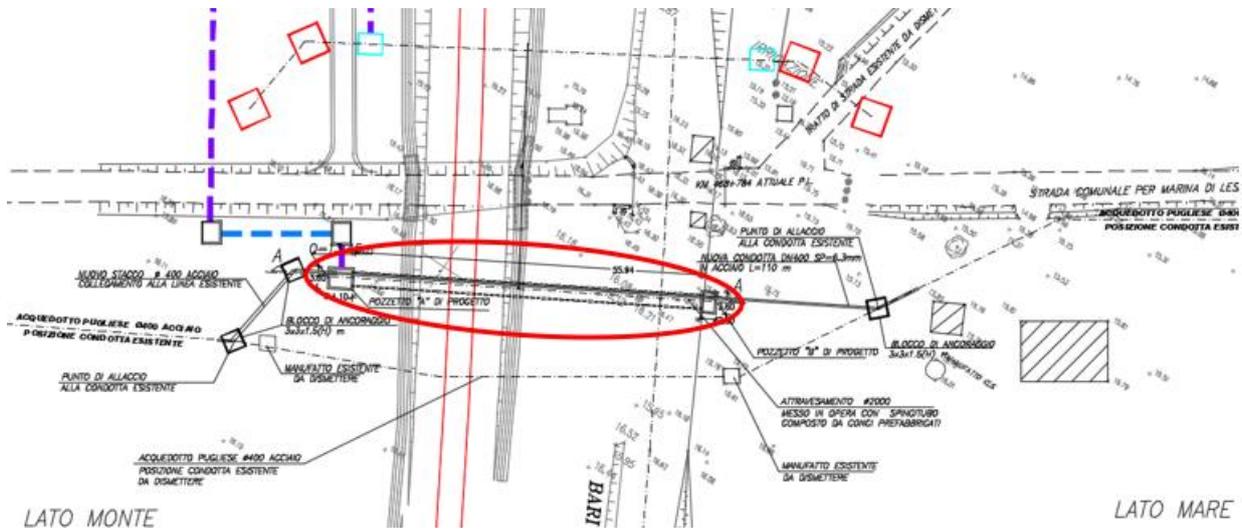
Stralcio planimetrico con indicazione del tombino scatolare 2x2m.
